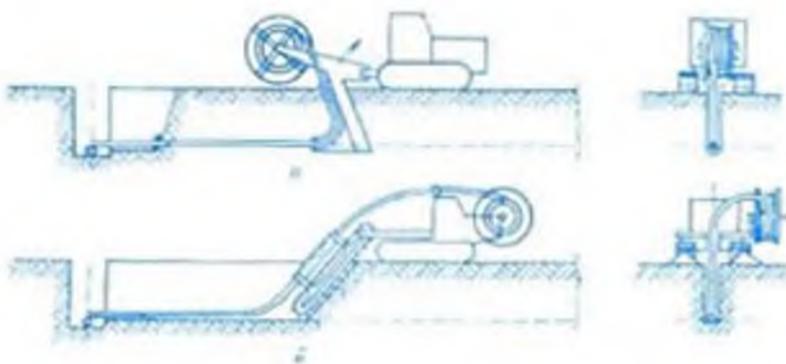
Технология укладки пластмассовых дренажных труб при строительстве закрытой сети: а — бес-траншейным способом; б — узкотраншейным способом.
